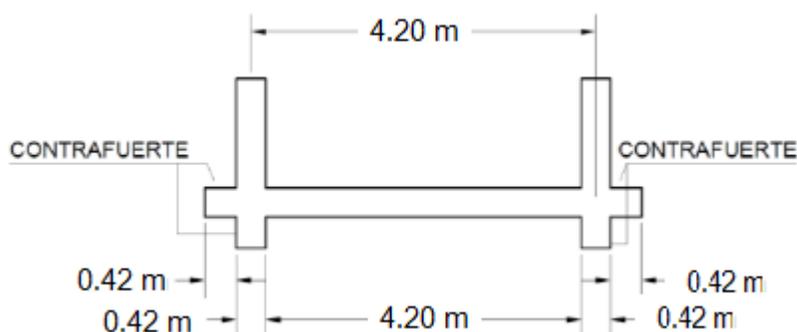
detalle de distancia de contrafuertes en paredes de 40 cms
